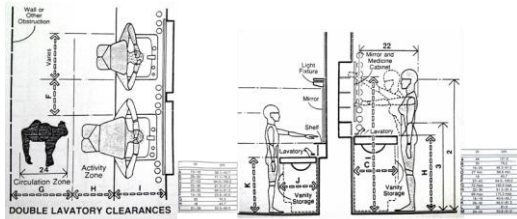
Ruang Gerak Zona Lavatory pada Desain
